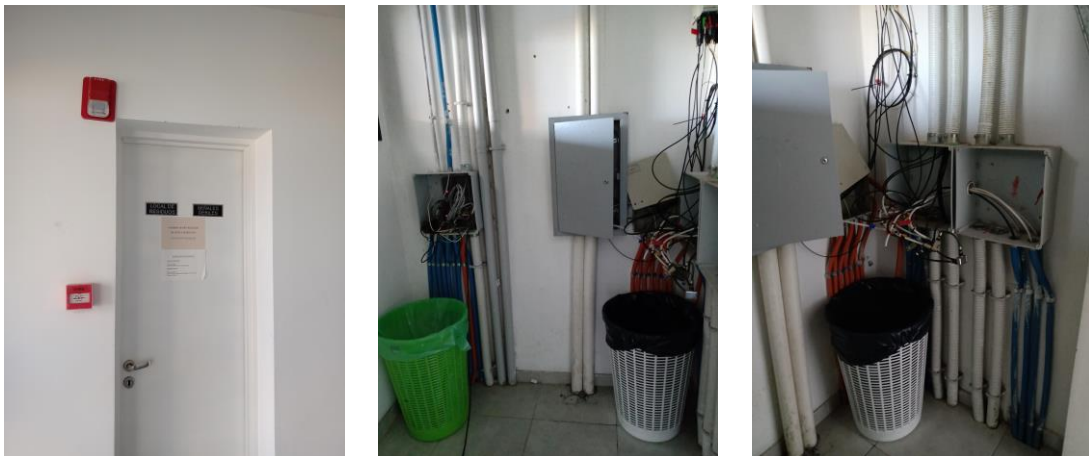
1.5.4 – 1.5.5 Instalación eléctrica
